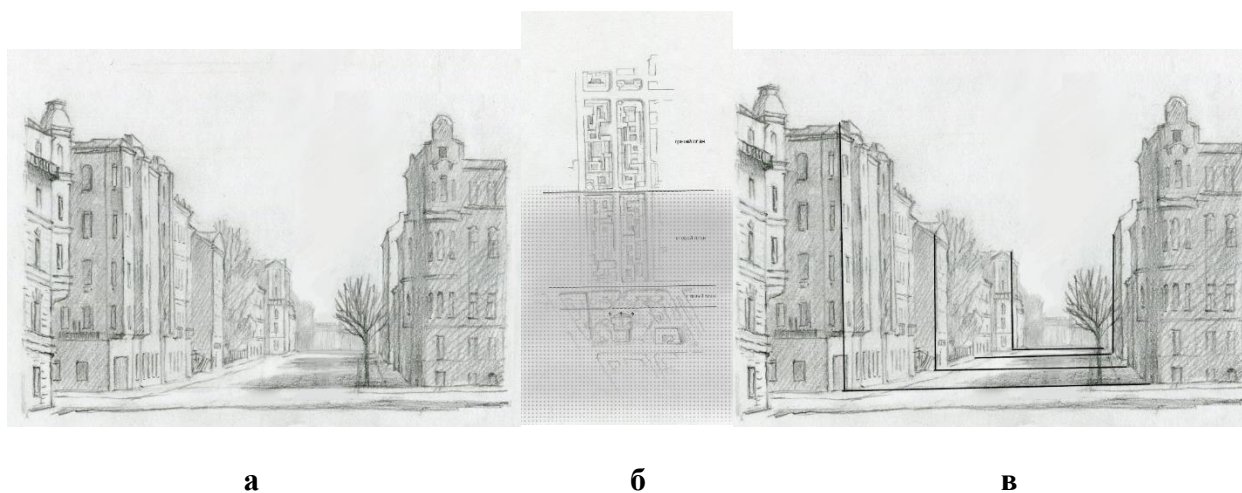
Третий план, а – композиционный рисунок третьего пространственного плана, б – границы третьего плана на схеме генплана, в – соотношение высотных характеристик зданий к третьей красноармейской улице
